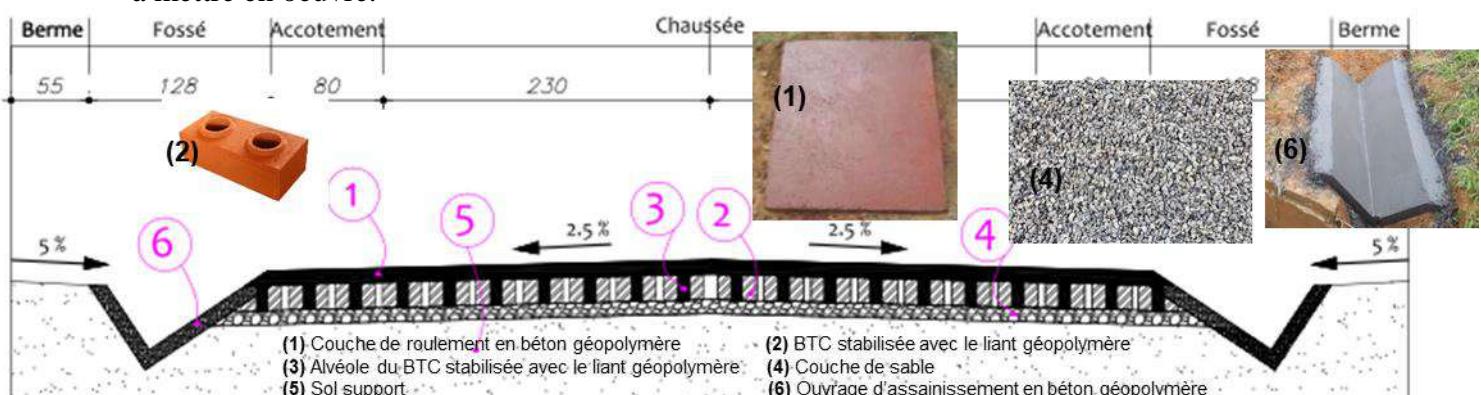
Modèle de disposition de couches de chaussées proposé avec ancrage sur le profil en travers de la chaussée
